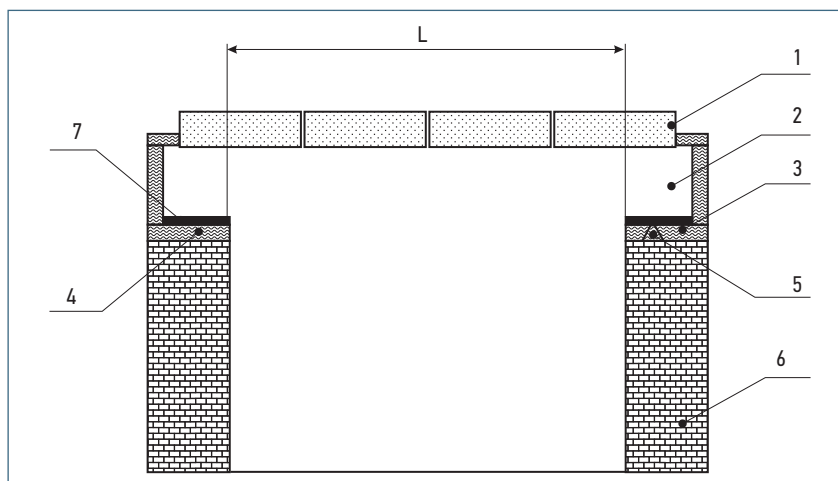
Пример расположения образца балочного элемента при проведении испытаний
